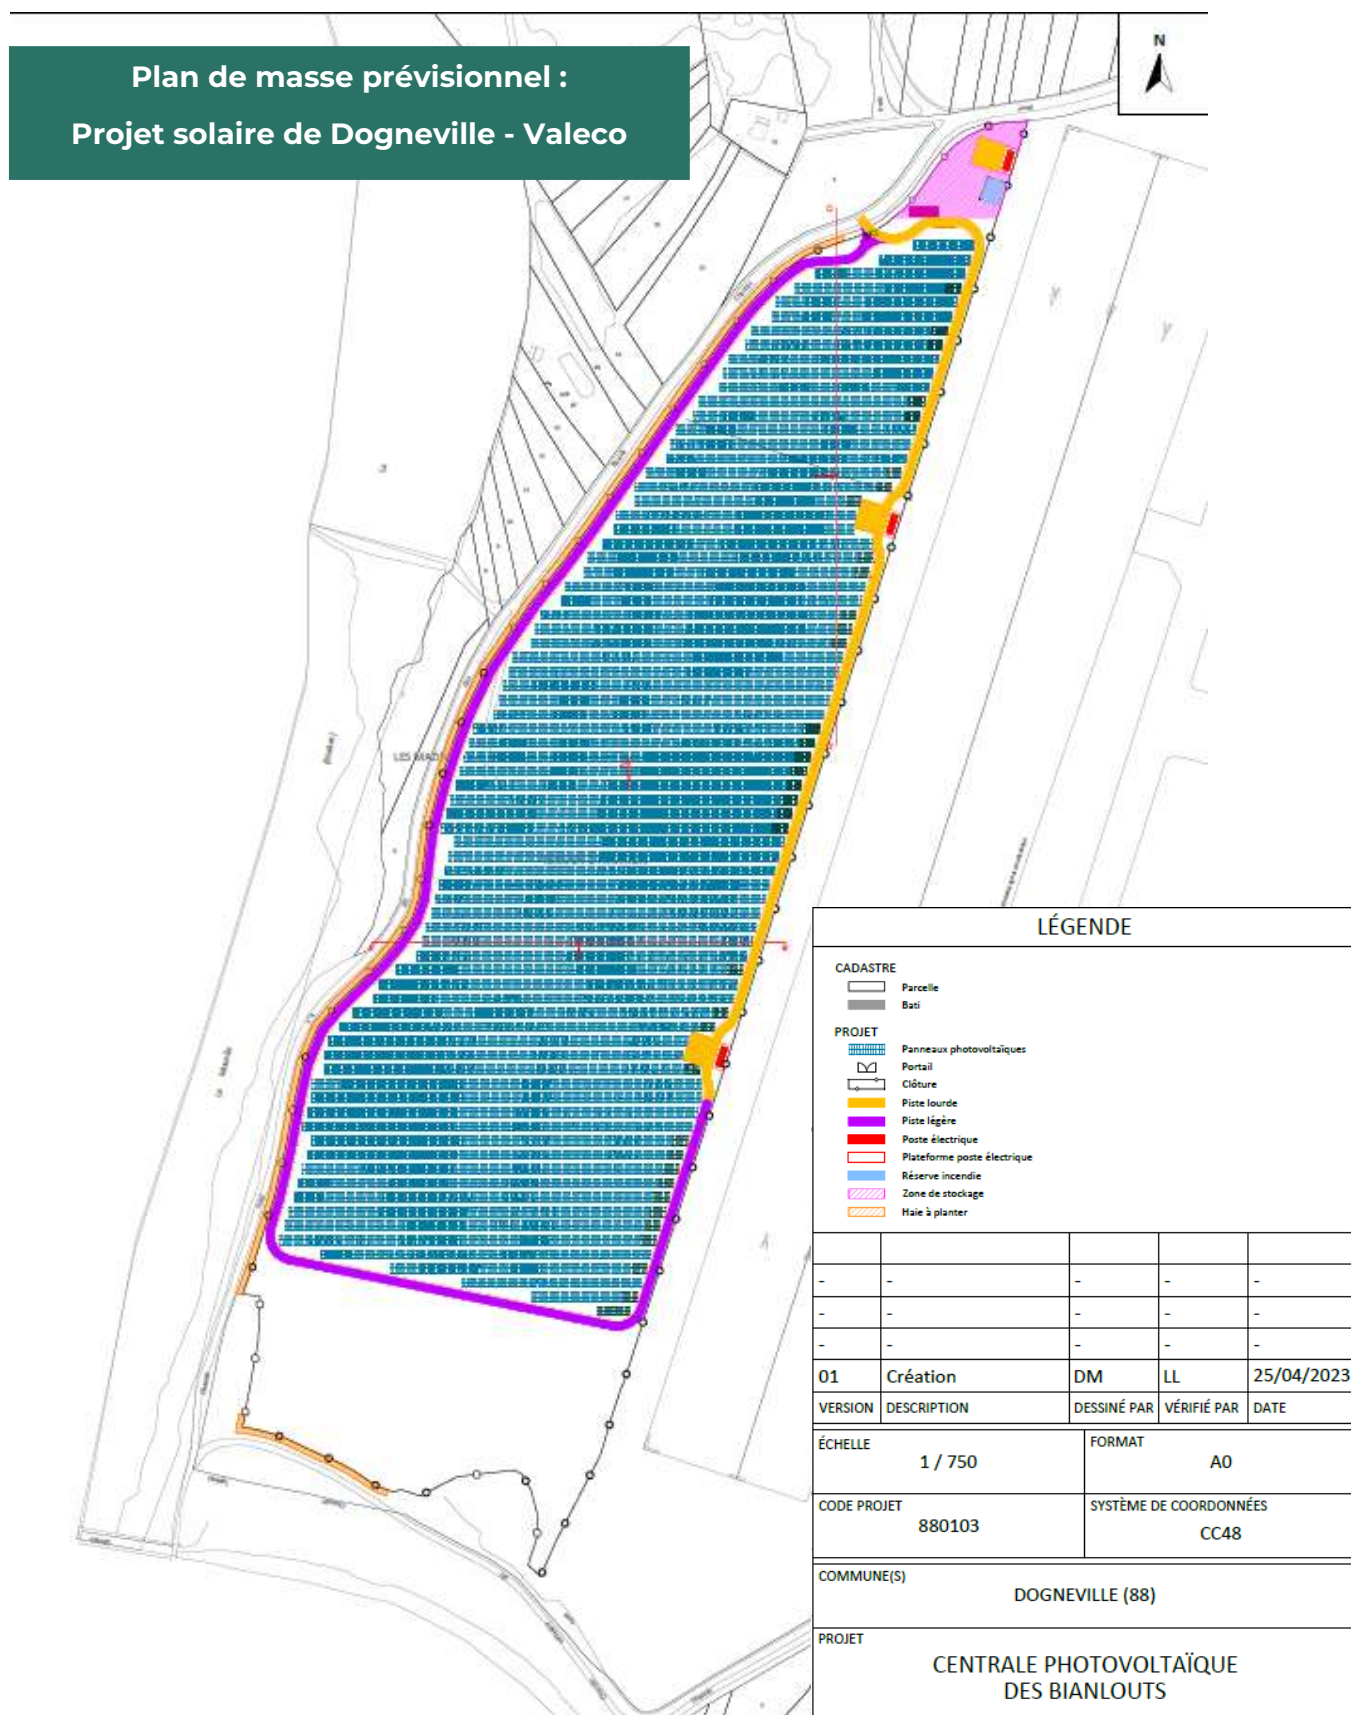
Plan de masse prévisionnel de la centrale photovoltaïque (Valeco)
